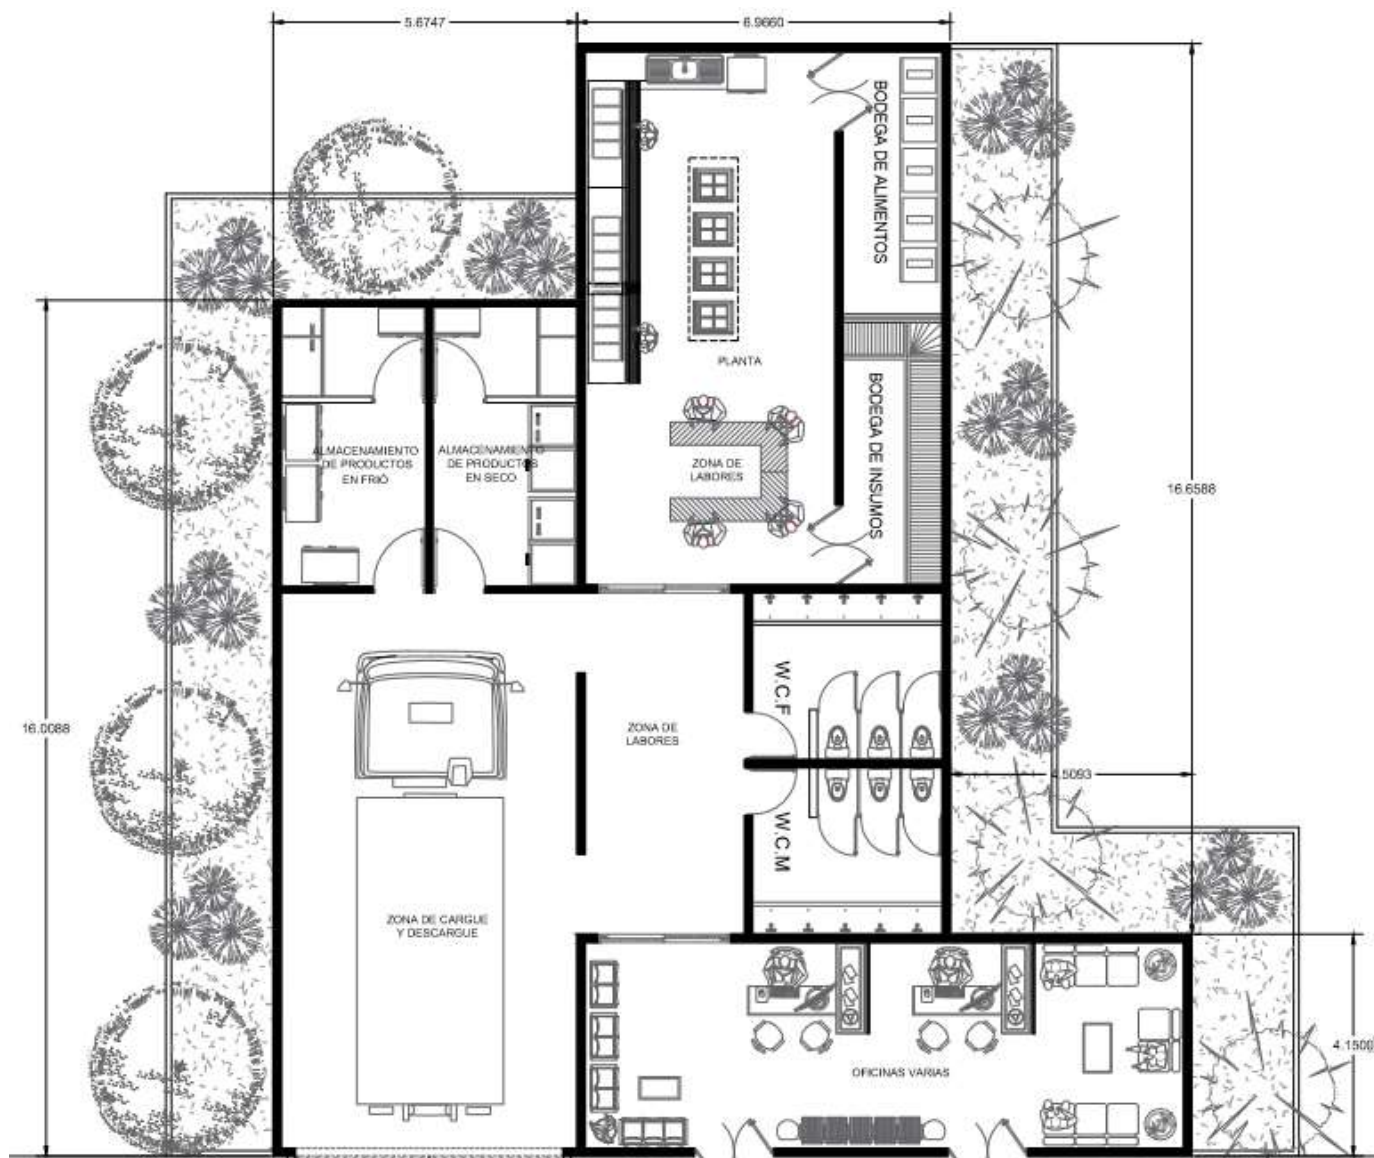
Plano horizontal de la planta Fuente: elaboración propia.
